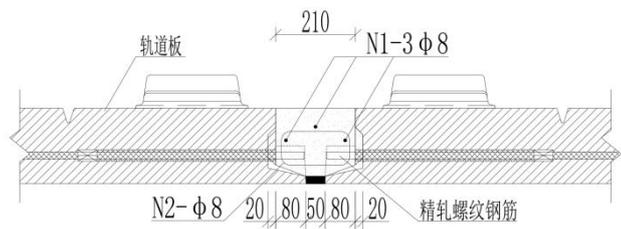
宽接缝钢筋横断面布置图 (单位: mm)
